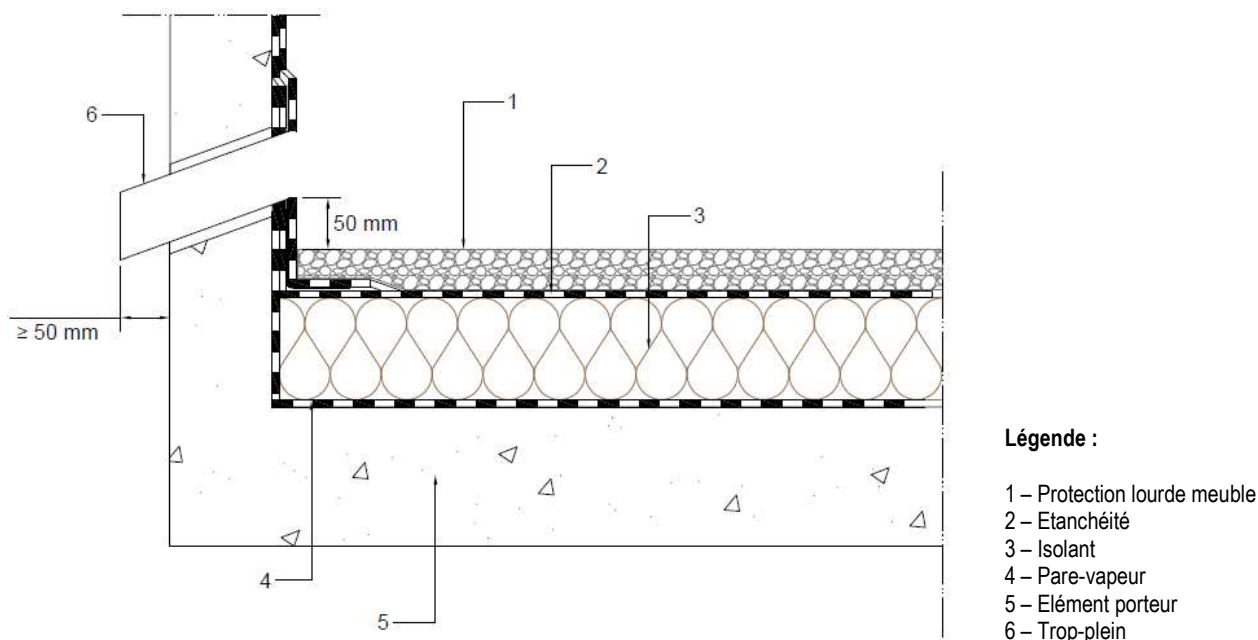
Maçonnerie - Positionnement altimétrique du trop-plein – toiture-terrasse étanchée avec protection lourde meuble
